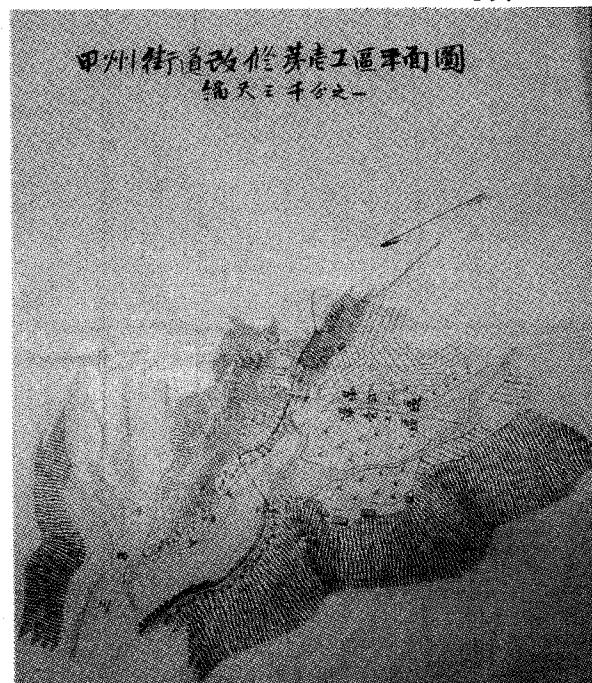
甲州街道第壱工区平面図 (S=1/3000, 撮影筆者)
